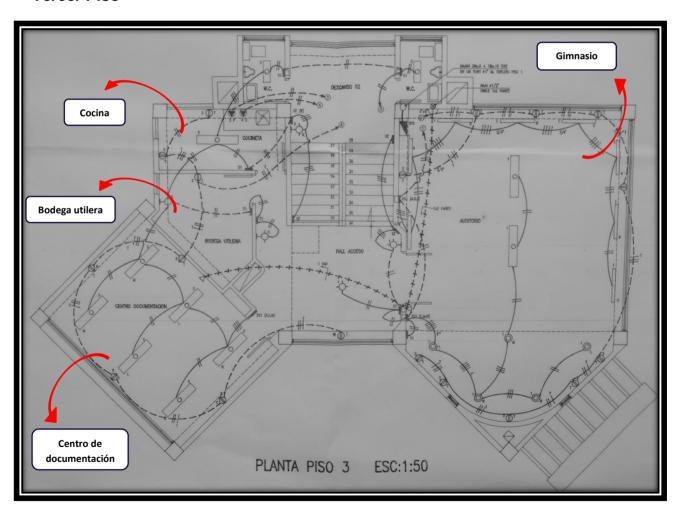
Cornare. (2008). Plano de Distribución del Sistema Eléctrico Planta Tercer Piso.
